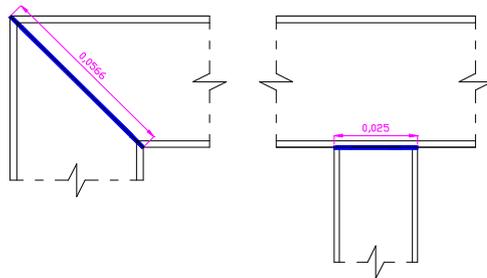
Suelda vista en planta (Izquierda: Perimetral; Derecha: Travesaño).
